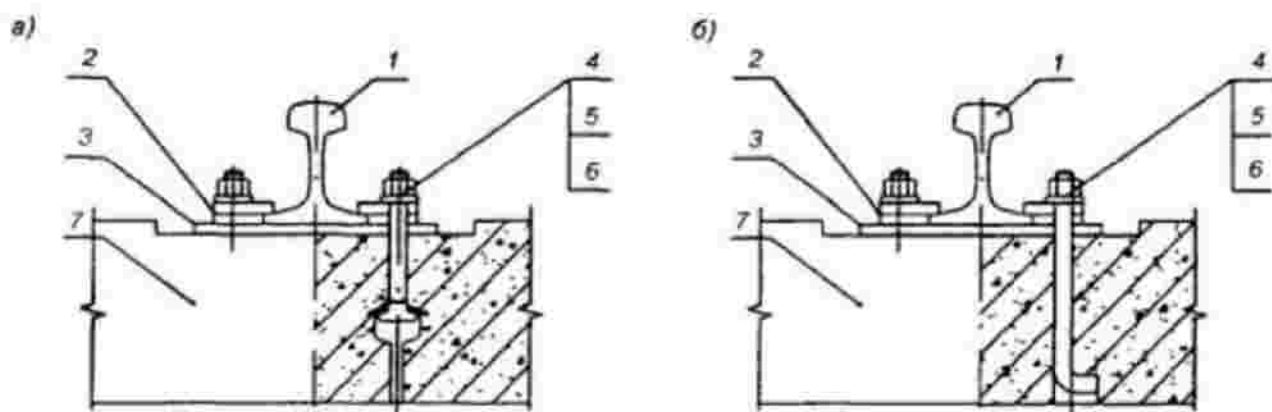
Промежуточное крепление рельса с железобетонной балкой
